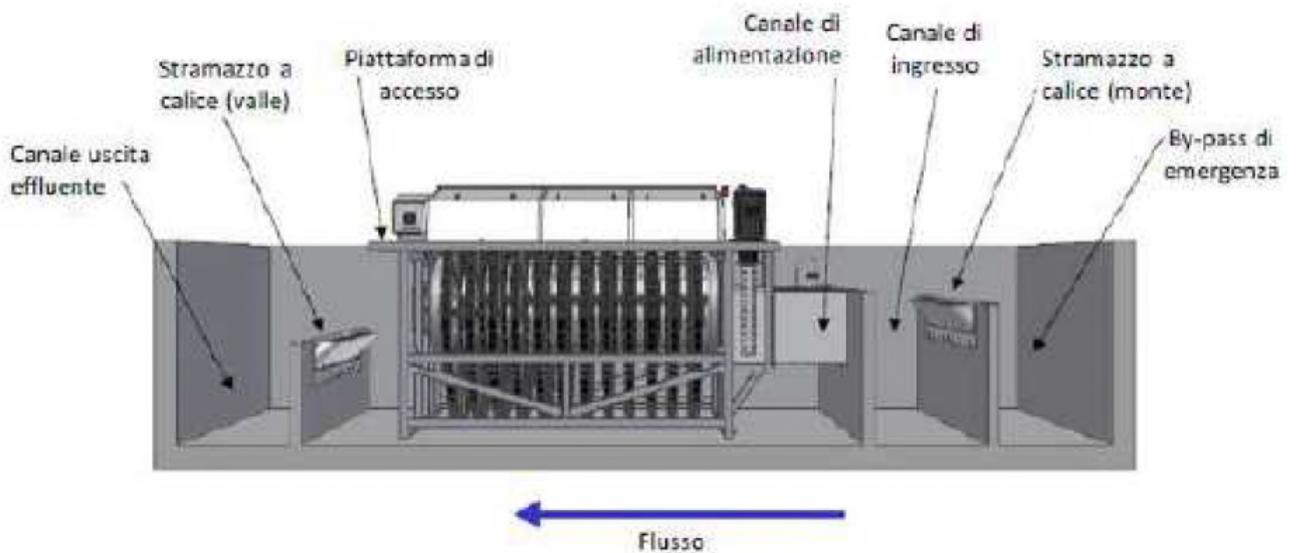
Sezione schematica dell'impianto di filtrazione a dischi.
